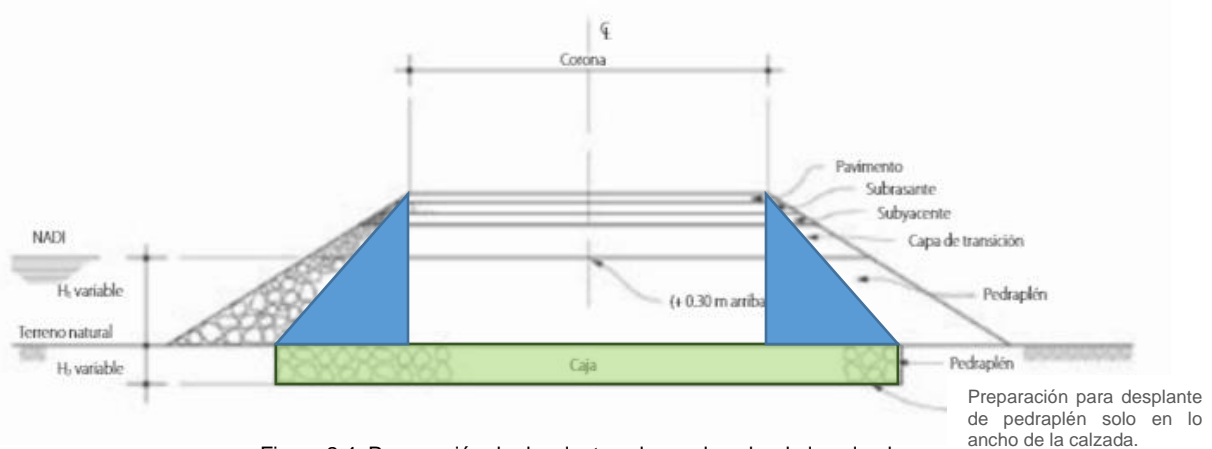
Preparación de desplante solo en el ancho de la calzada
